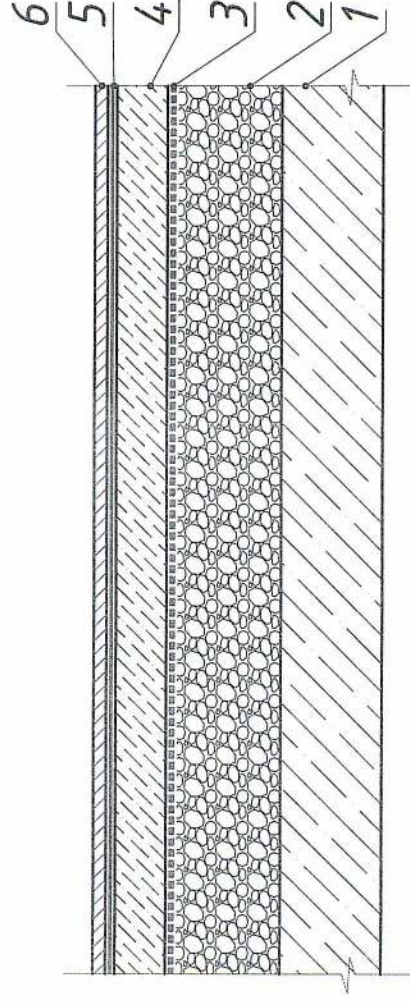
Принципиальная схема конструктивного исполнения перекрытия выполняемого по железобетонному основанию (полы по железобетонному перекрытию над проездами, неотапливаемым подвалом, проветриваемым подпольем и т.п.)
